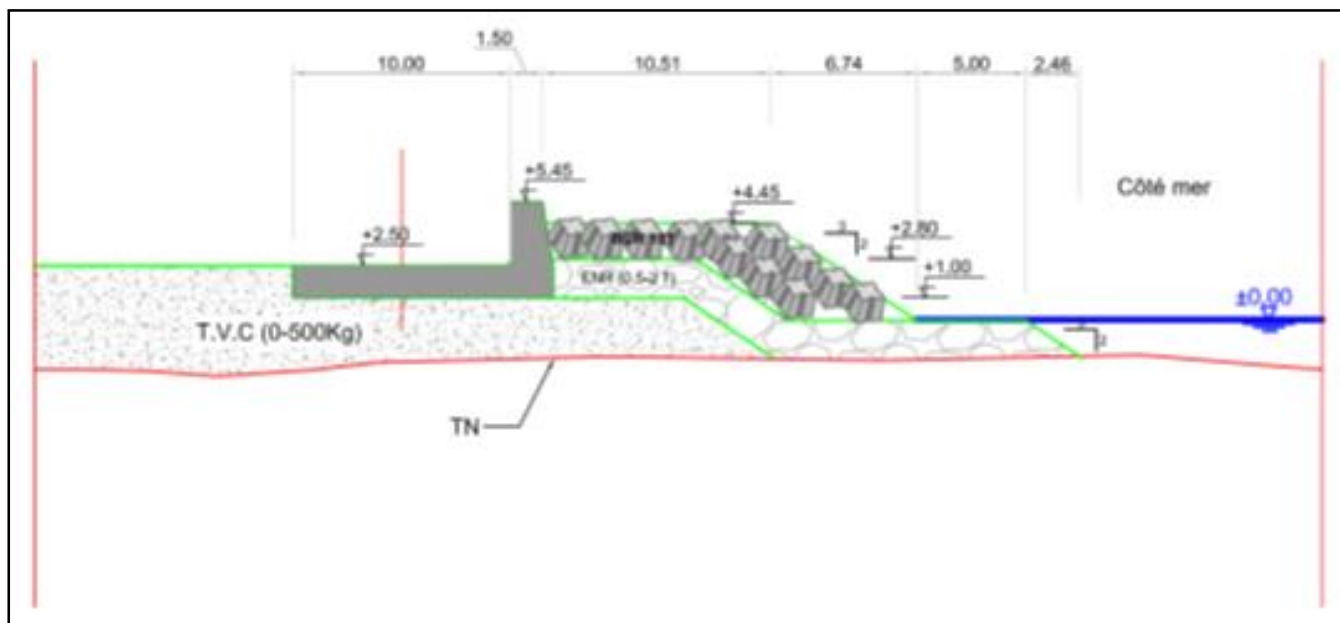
Variante 01 – jetée secondaire – profil enracinement
